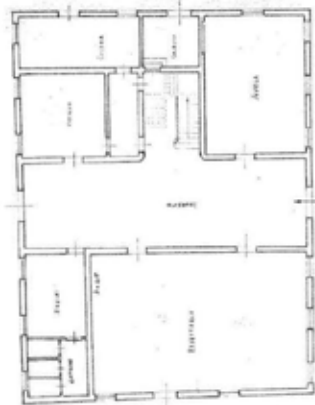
Fabbricato Principale. Planimetria Piano Terra
